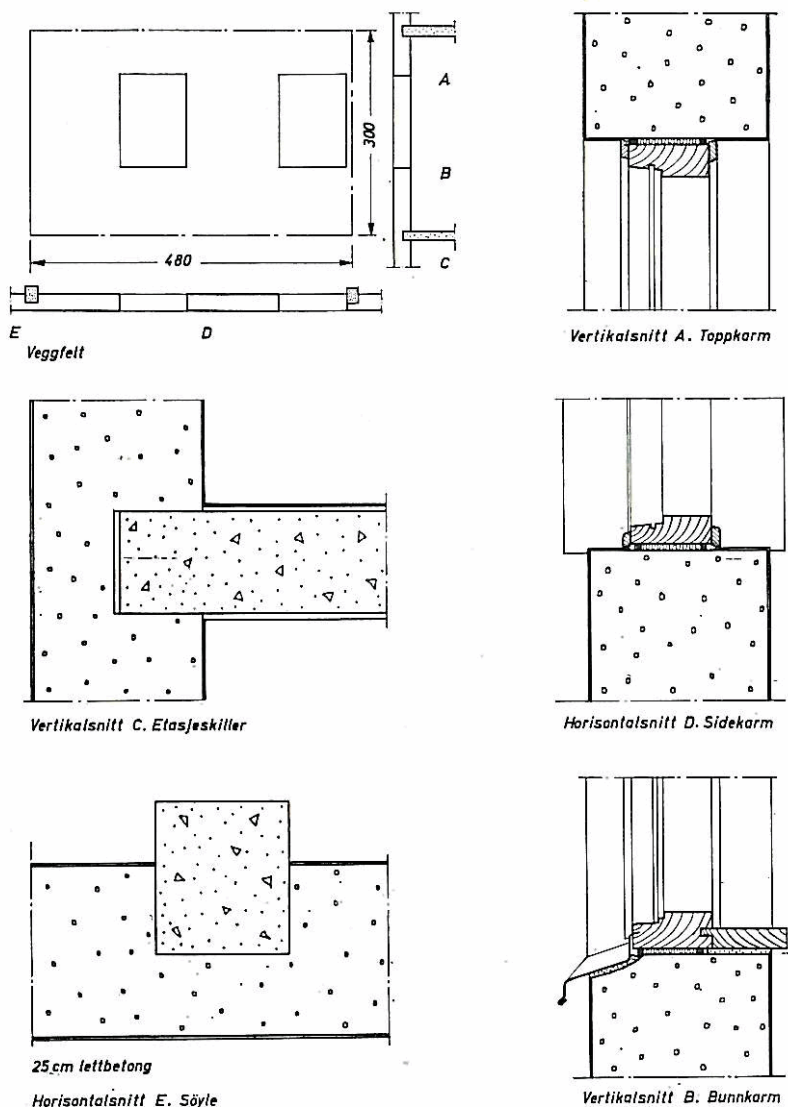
Lettbetongvegg. Lettbetongvegg av 25 cm gassbetong 0,4 blokk eller stav presisjons-skåret, lagt opp i lim. Utvendig tynnpuss som påføres som to gangers slemming med gresskost med minst ett døgn mellomrom. Første slemmingsstrøk filses, siste strøk stoples. Innvendig behandling med tynnpuss som trekkes på og filses slik at det fremkommer et beleg på 2—3 mm. ● Lighthweight concrete wall. This wall is built of precision-cut, glue-jointed gas concrete blocks or oblong units. The external surface is covered with a "thin rendering" applied in two coats with a semi-stiff fibre-brush. The finishing coat is applied at least 24 hours after the first coat, and is stippled. The internal finish of the wall consists of thin plastering, which is applied and felt-floated so as to produce a coat 2 to 3 mm in thickness.
